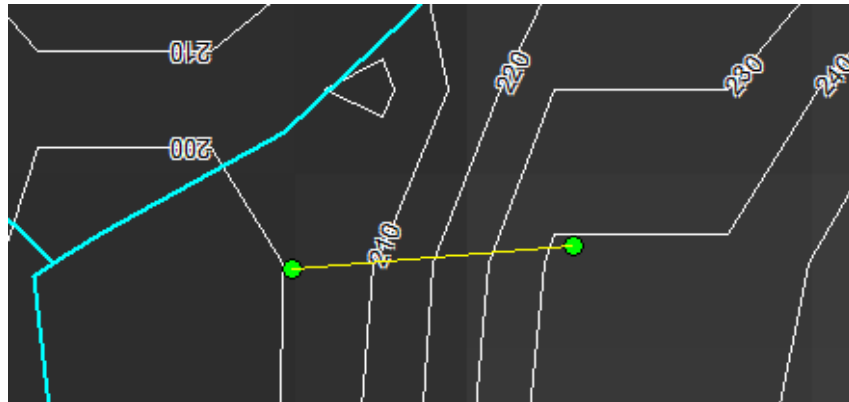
Vista aérea de tubería forzada alternativa II. Fuente: Elaboración propia
